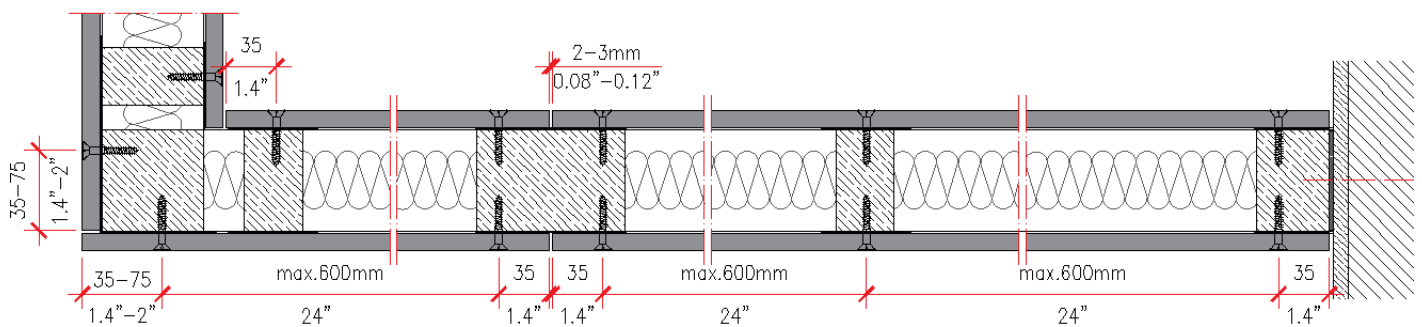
Secção horizontal da parede, estrutura de madeira
